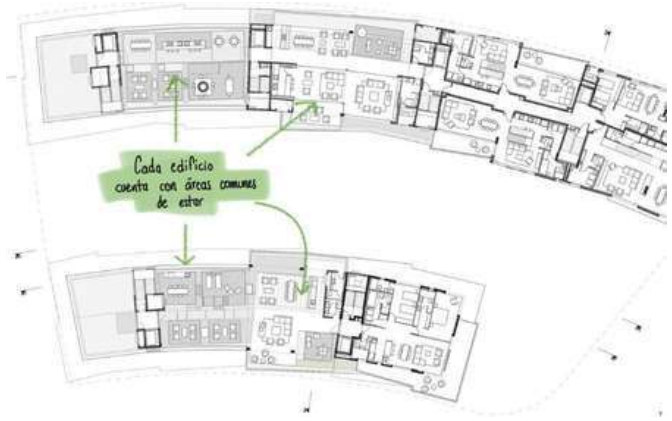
Planta arquitectónica intervenida con análisis.
